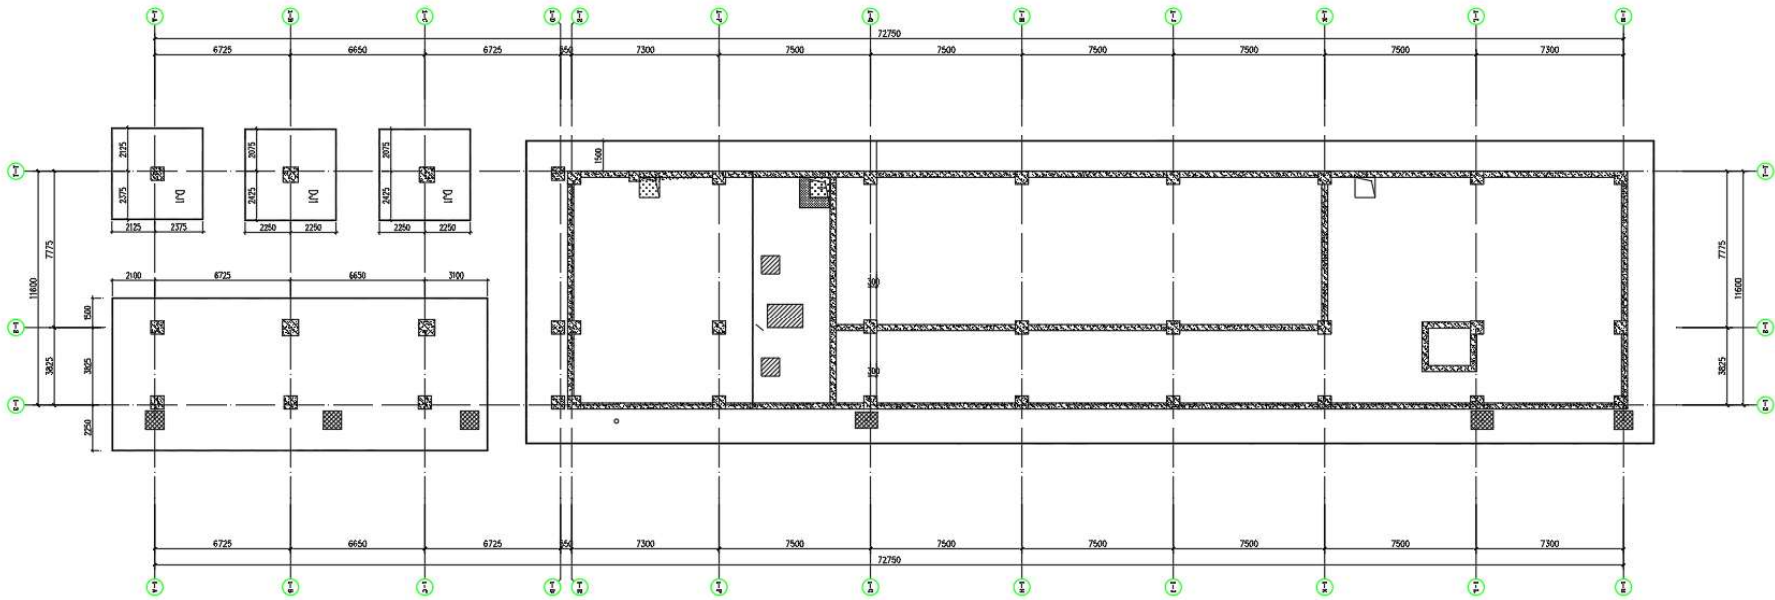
办公楼（含地下消防水池）基础平面布置图
